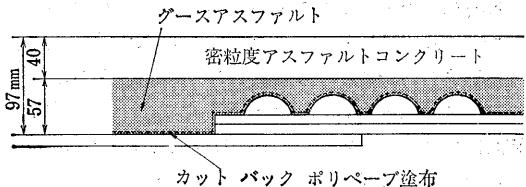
新淀川大橋鋼床版舗装（昭和39年施工）
